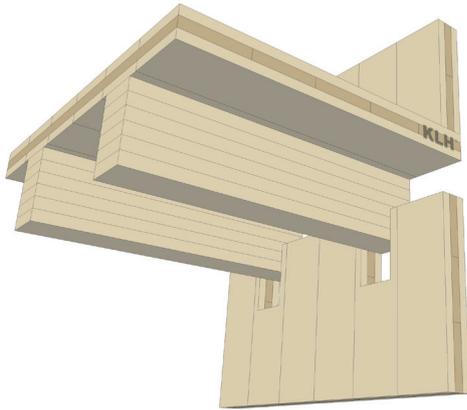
Hueco adaptado para los nervios en el elemento de pared
